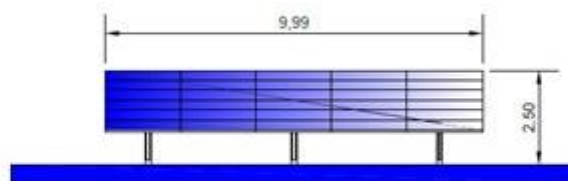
Plans de face et de coupe des structures fixes en pieux battus
